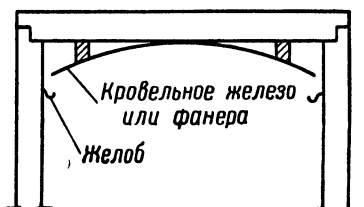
Отвод грунтовых вод в полевых подземных выработках посредством зонтов
